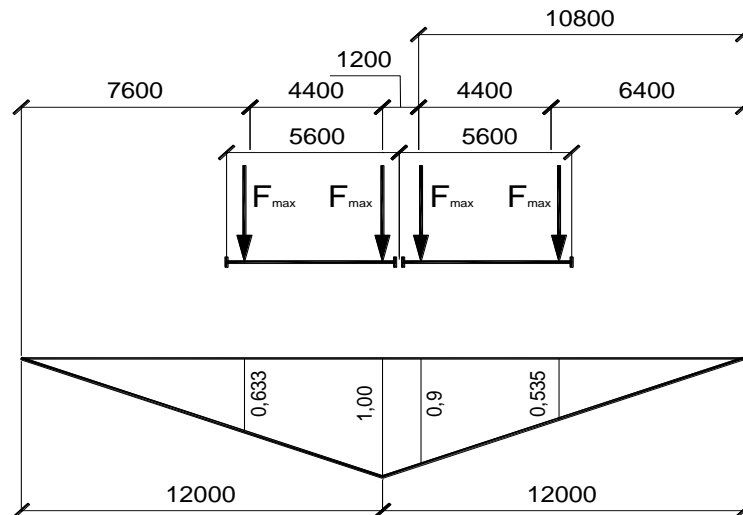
Лінія впливу тиску на колону при встановленні кранового навантаження в не вигідне положення
